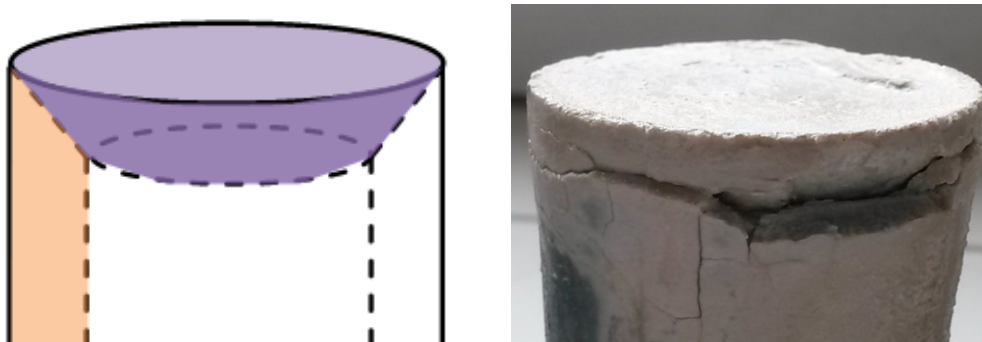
Plans de fissuration des éprouvettes cylindriques.
